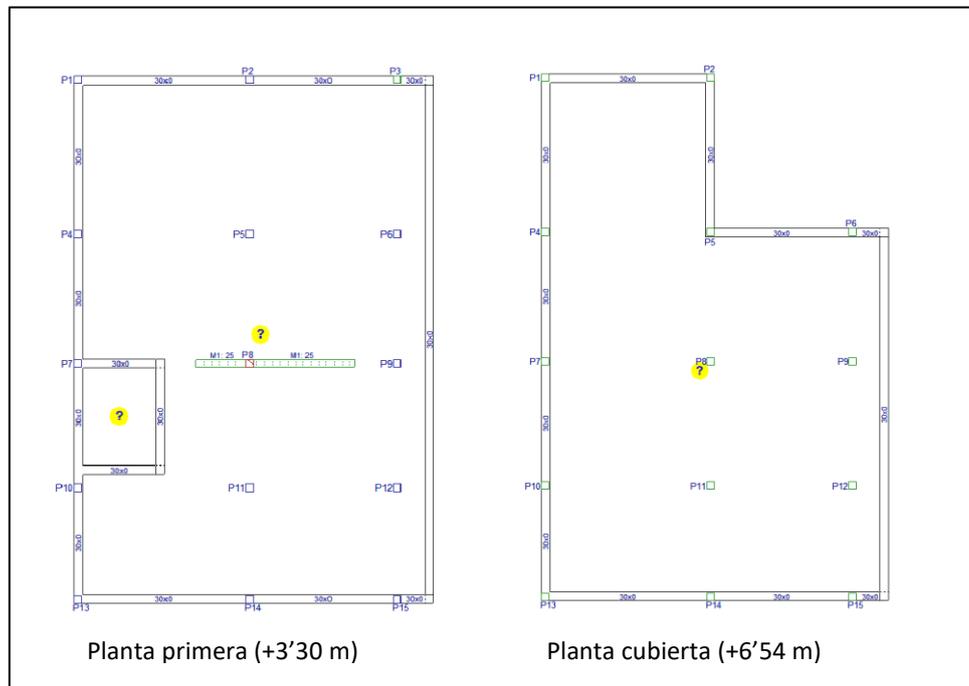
11. Recorte de pantalla, Vistas plantas con vigas en Cypecad
